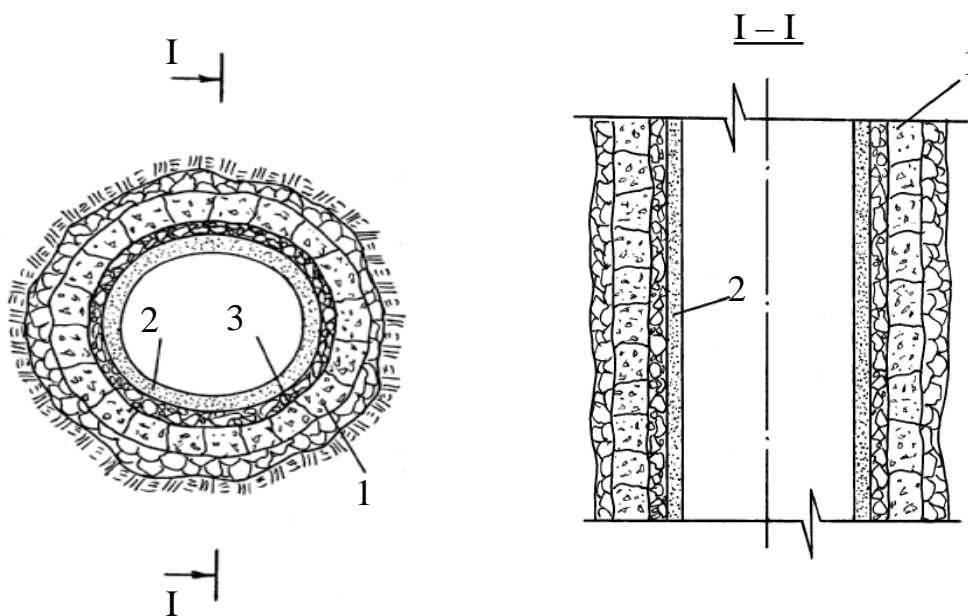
Схема зведення додаткового підсилювального бетонного кріплення у стволі: 1 і 2 – відповідно зруйноване й знову зведене підсилювальне бетонеі кріплення; 3 – породна забутівка
